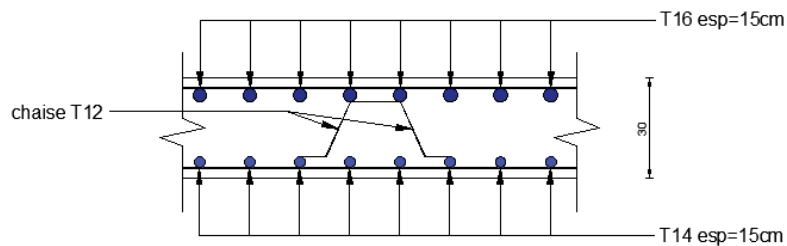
Schéma de ferrailage de la dalle du radier sur appui sens x-x.
